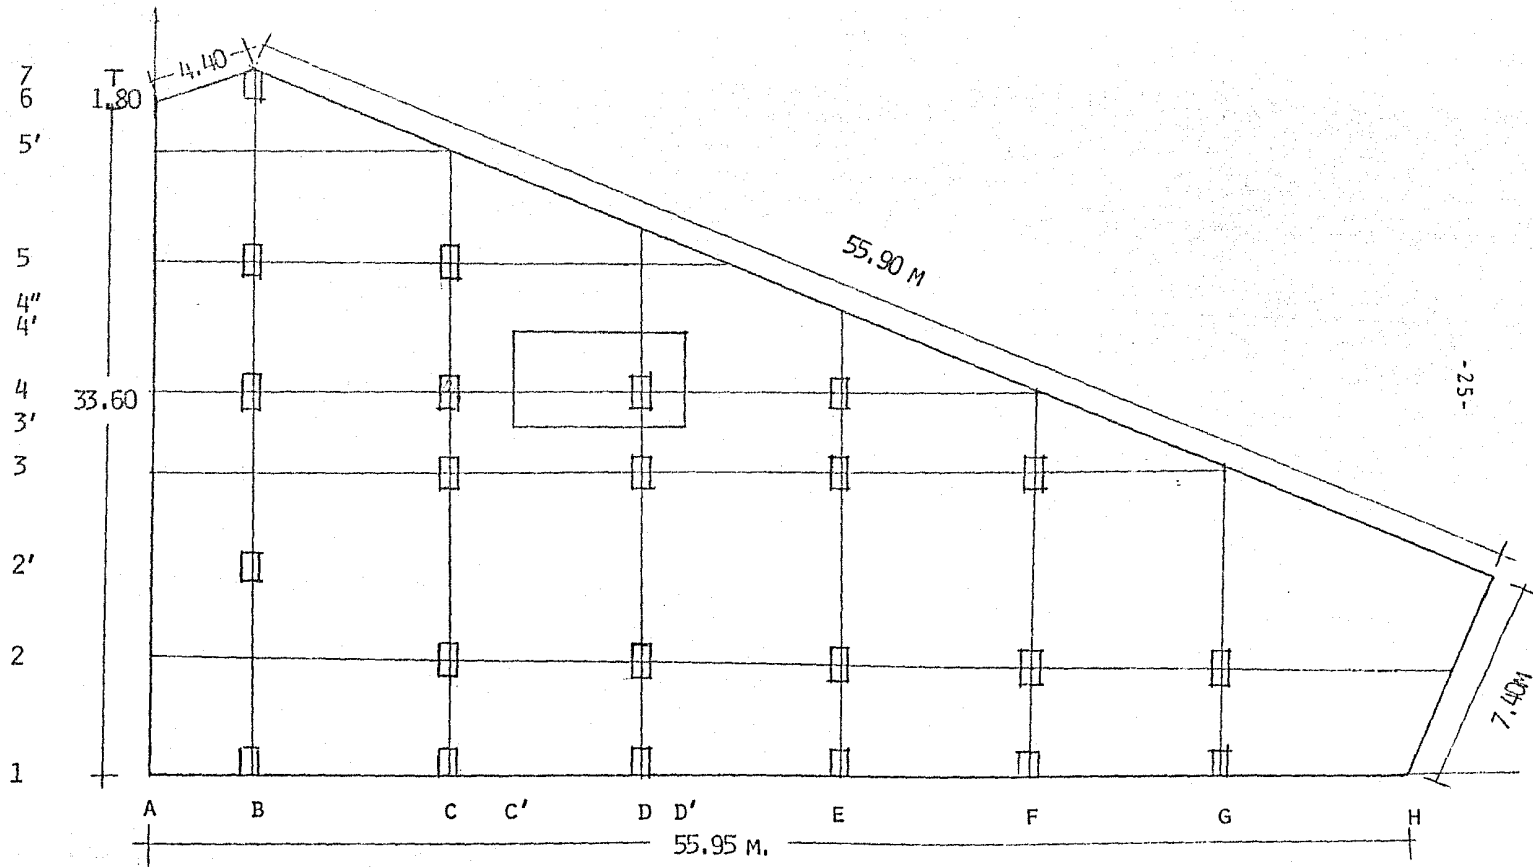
PLANTA (DISTRIBUCIÓN DE COLUMNAS)
